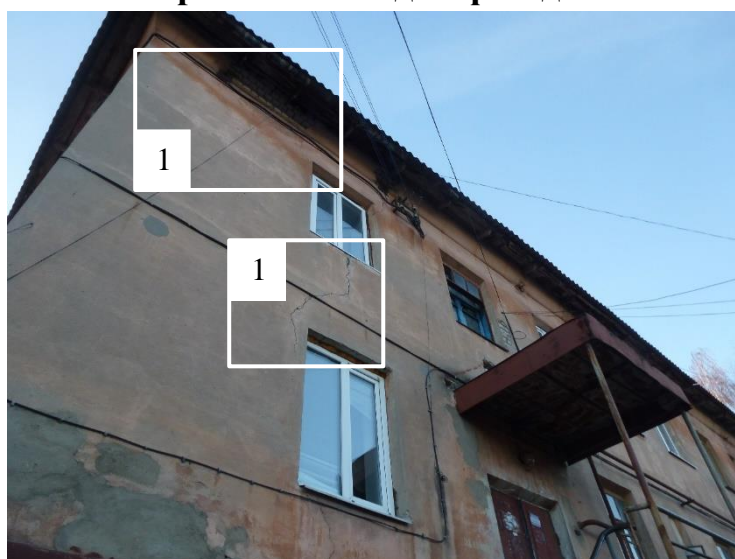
Фрагмент фасада. Дефекты: 1 – отслоение отделочного слоя, повреждение кирпичной кладки; 2- трещина.
